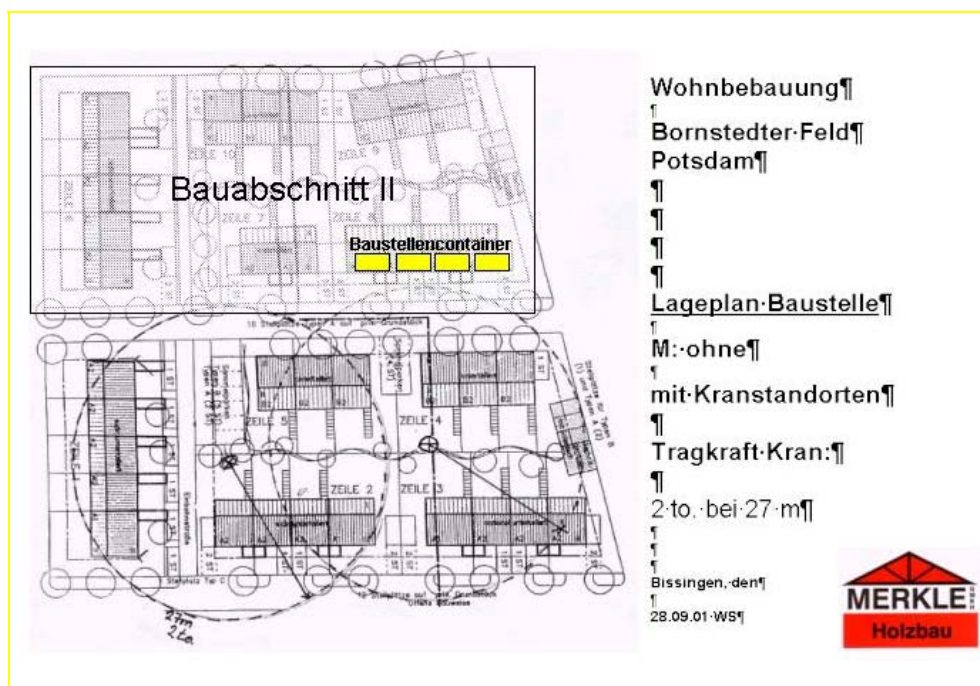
Lageplan Bornstedter Feld mit Kranstandorten
